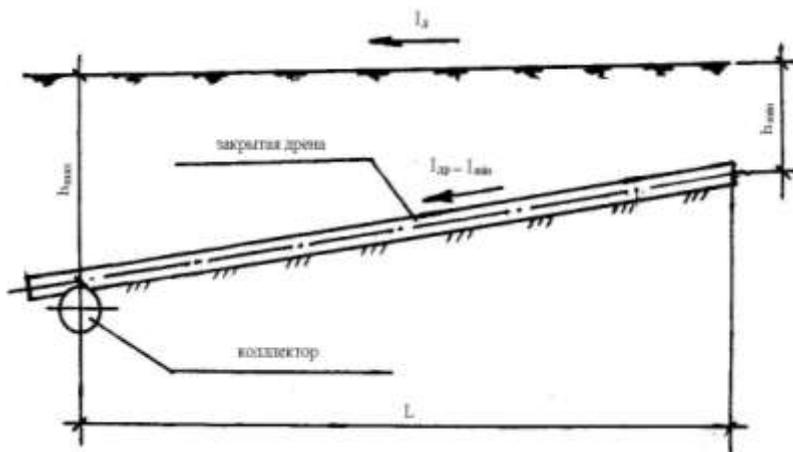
Проектирование уклона дренажа на слабоуклонных и безуклонных участках
